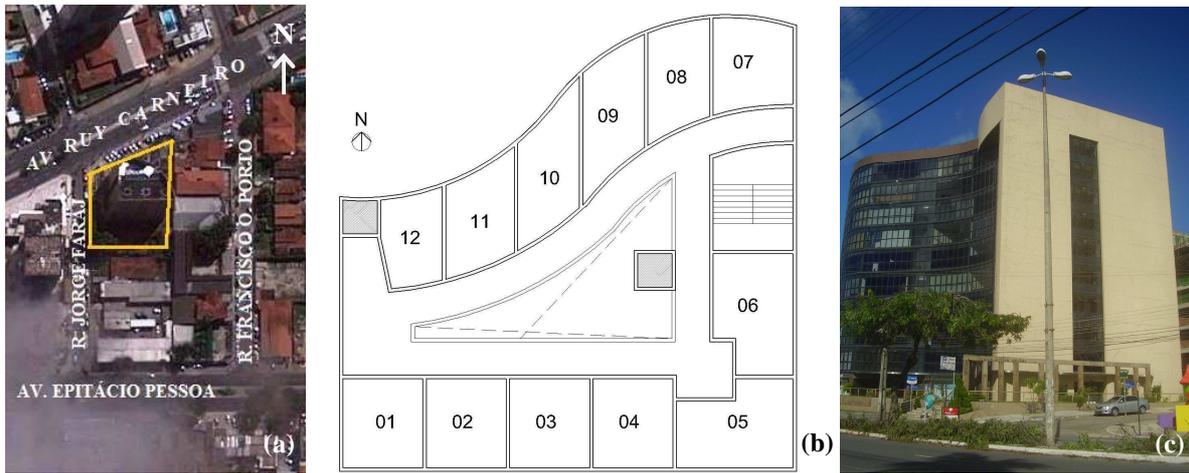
Trade Office Center: imagem aérea (a) (GOOGLE EARTH, 2011), croqui do pavimento tipo (b) e vista noroeste (c).
